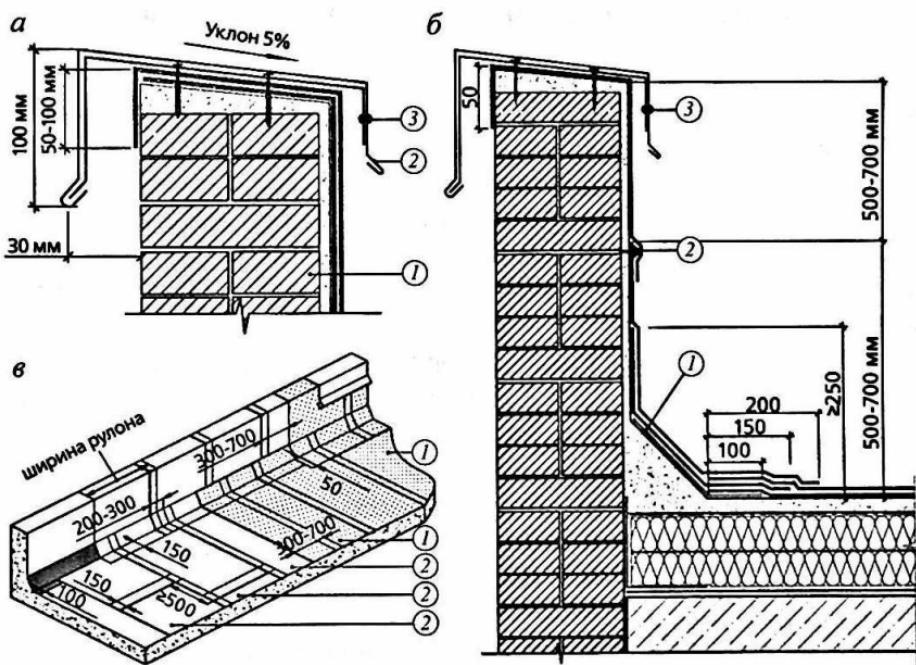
Примыкание кровельного ковра к парапетной стене:
